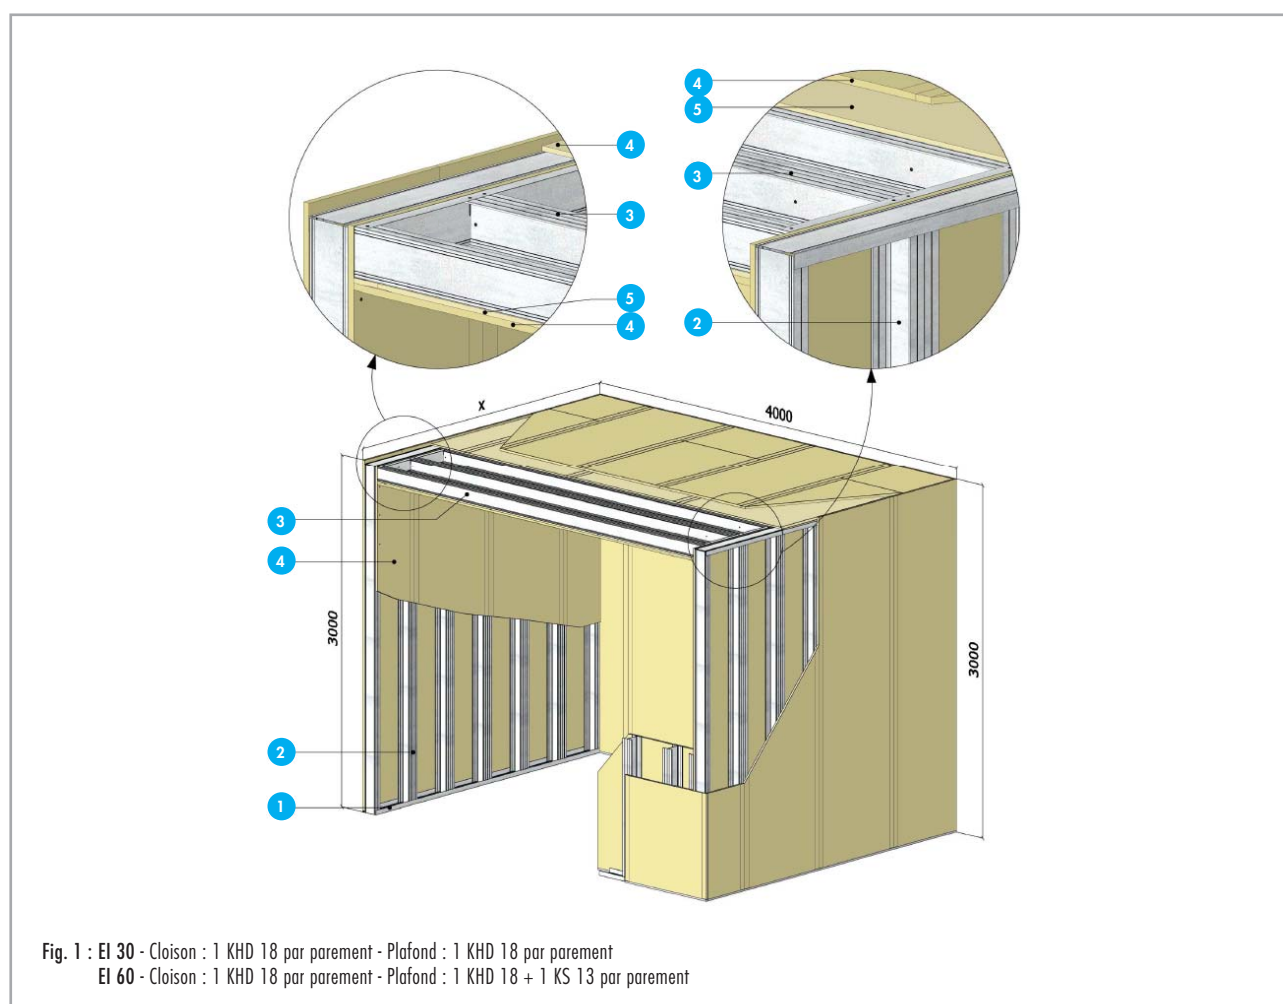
EI 30 - Cloison : 1 KHD 18 par parement - Plafond : 1 KHD 18 par parement
